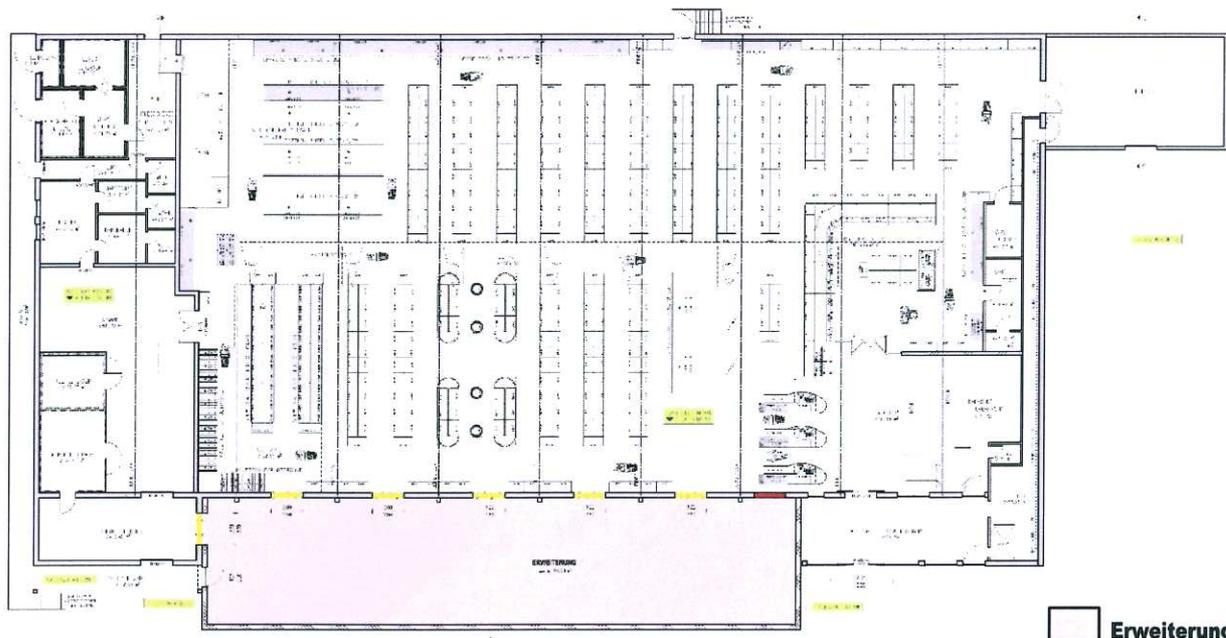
Vorhabenplan als Grundlage des Bebauungsplans
